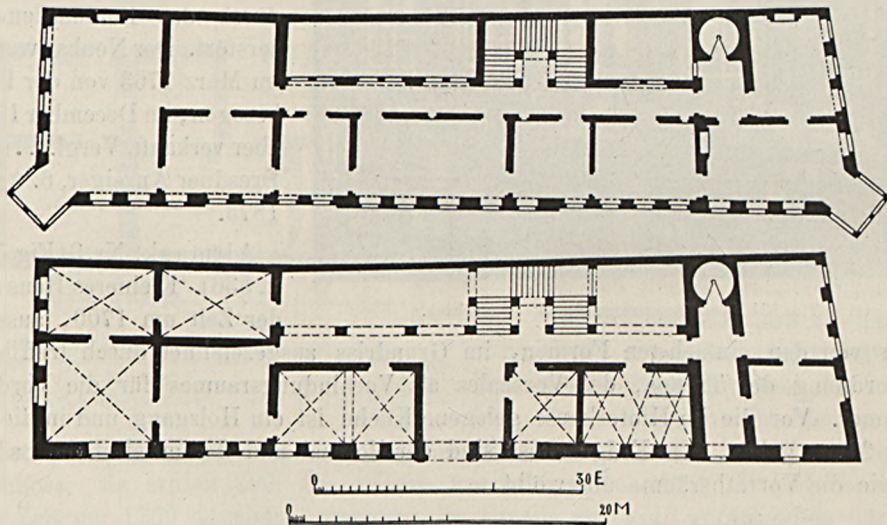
u. 538. Köckeritz'sches Haus, 1760 abgebrannt. Grundriss des Erd- und Obergeschosses.
